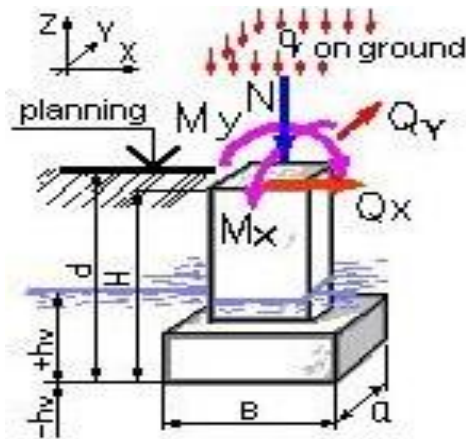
Схема стовпчастого фундаменту
